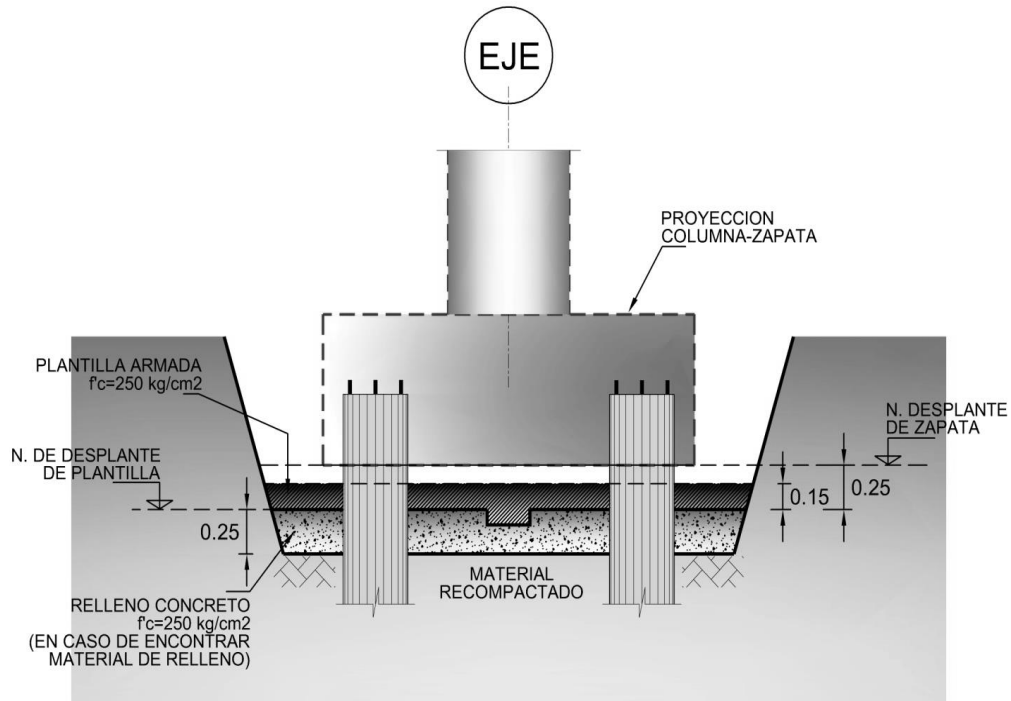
Excavación para alojar zapata columna desplantada en roca.
